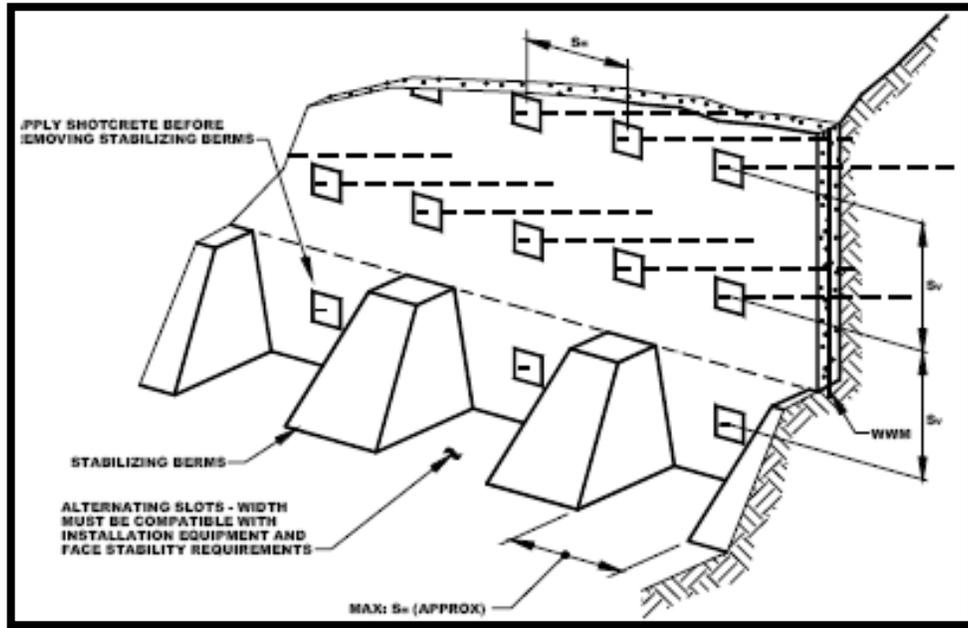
Paso 8°: Excavación por paños alternados del talud o banquetta hasta dejarlo a plomo
